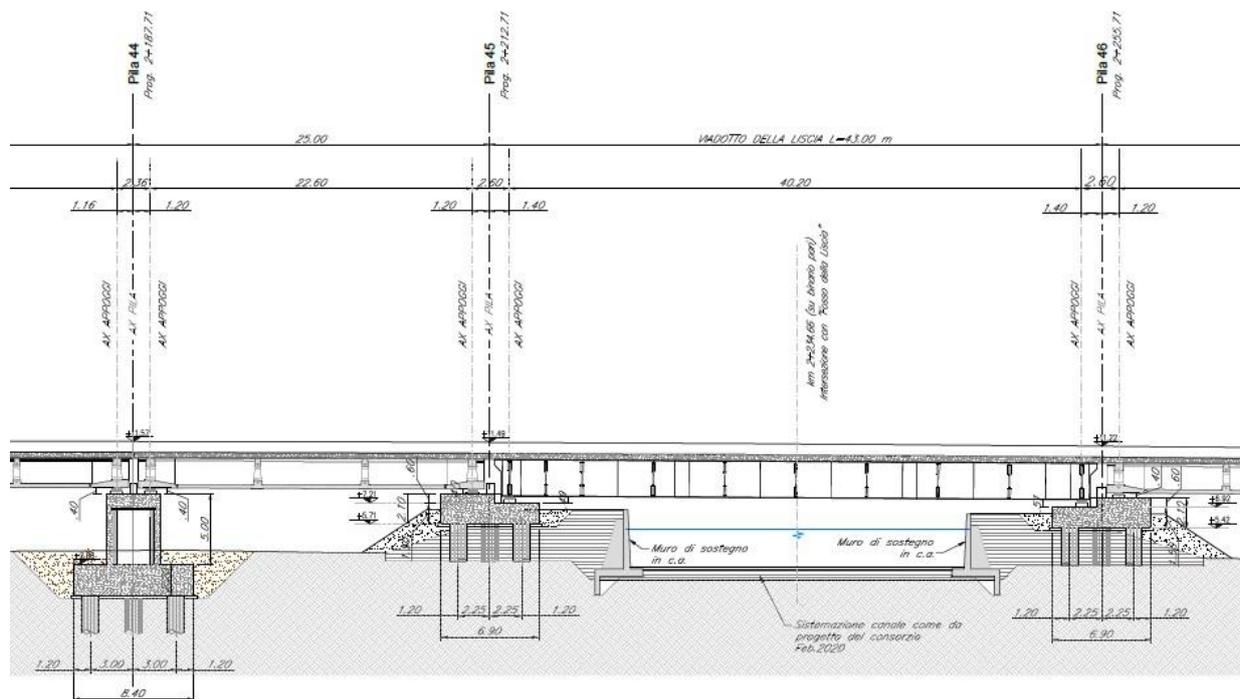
Sezione longitudinale stralcio viadotto Esino pile 44-45-46 - progetto esecutivo variante
